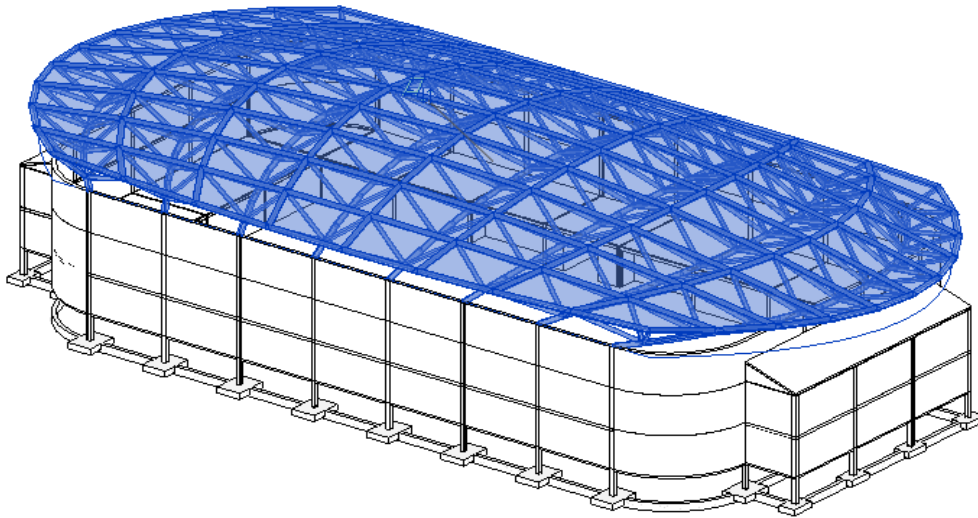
Acomodamiento de la cubierta sobre la construcción
